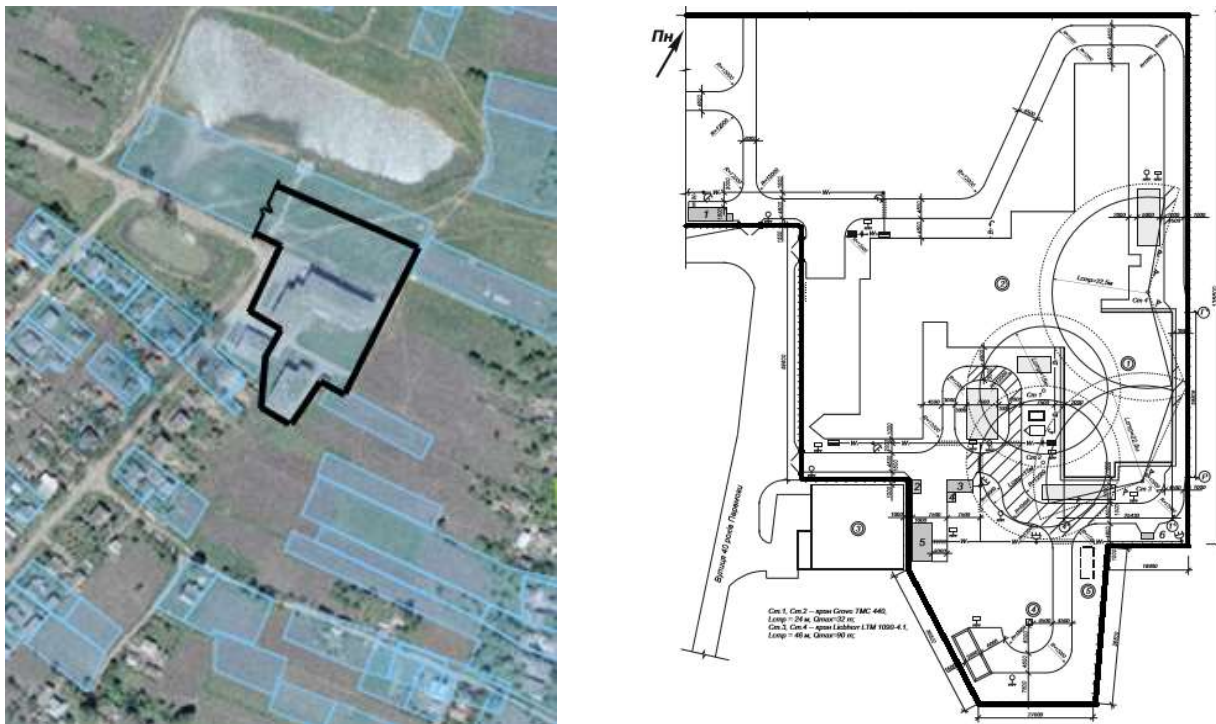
Приклад застосування публічної кадастрової карти для створення будівельного генерального плану
